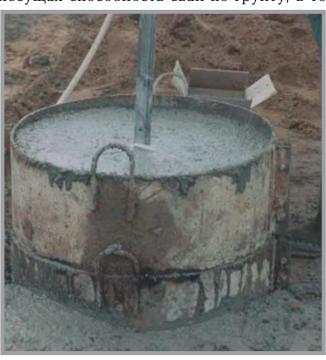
Уровень бетона до ЭРГТ обработки сваи
